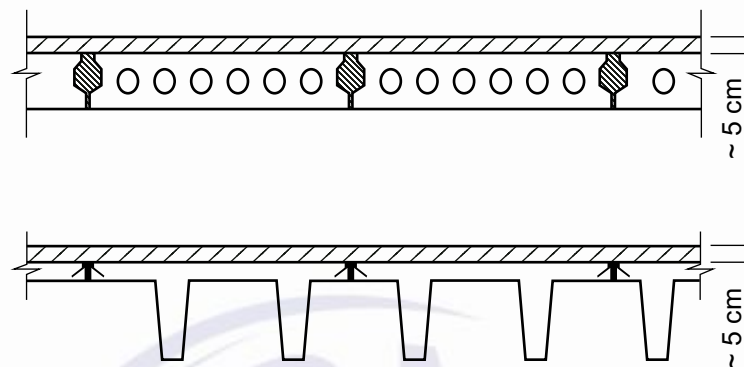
Espossuras médias mínimas de capeamento das lajes
